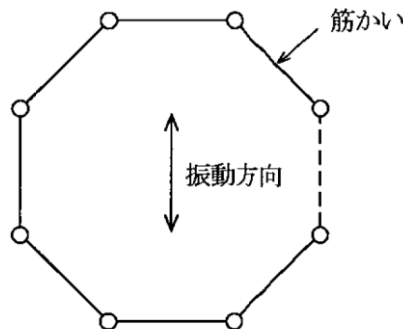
筋かいの配置及び振動方向(平面図)
